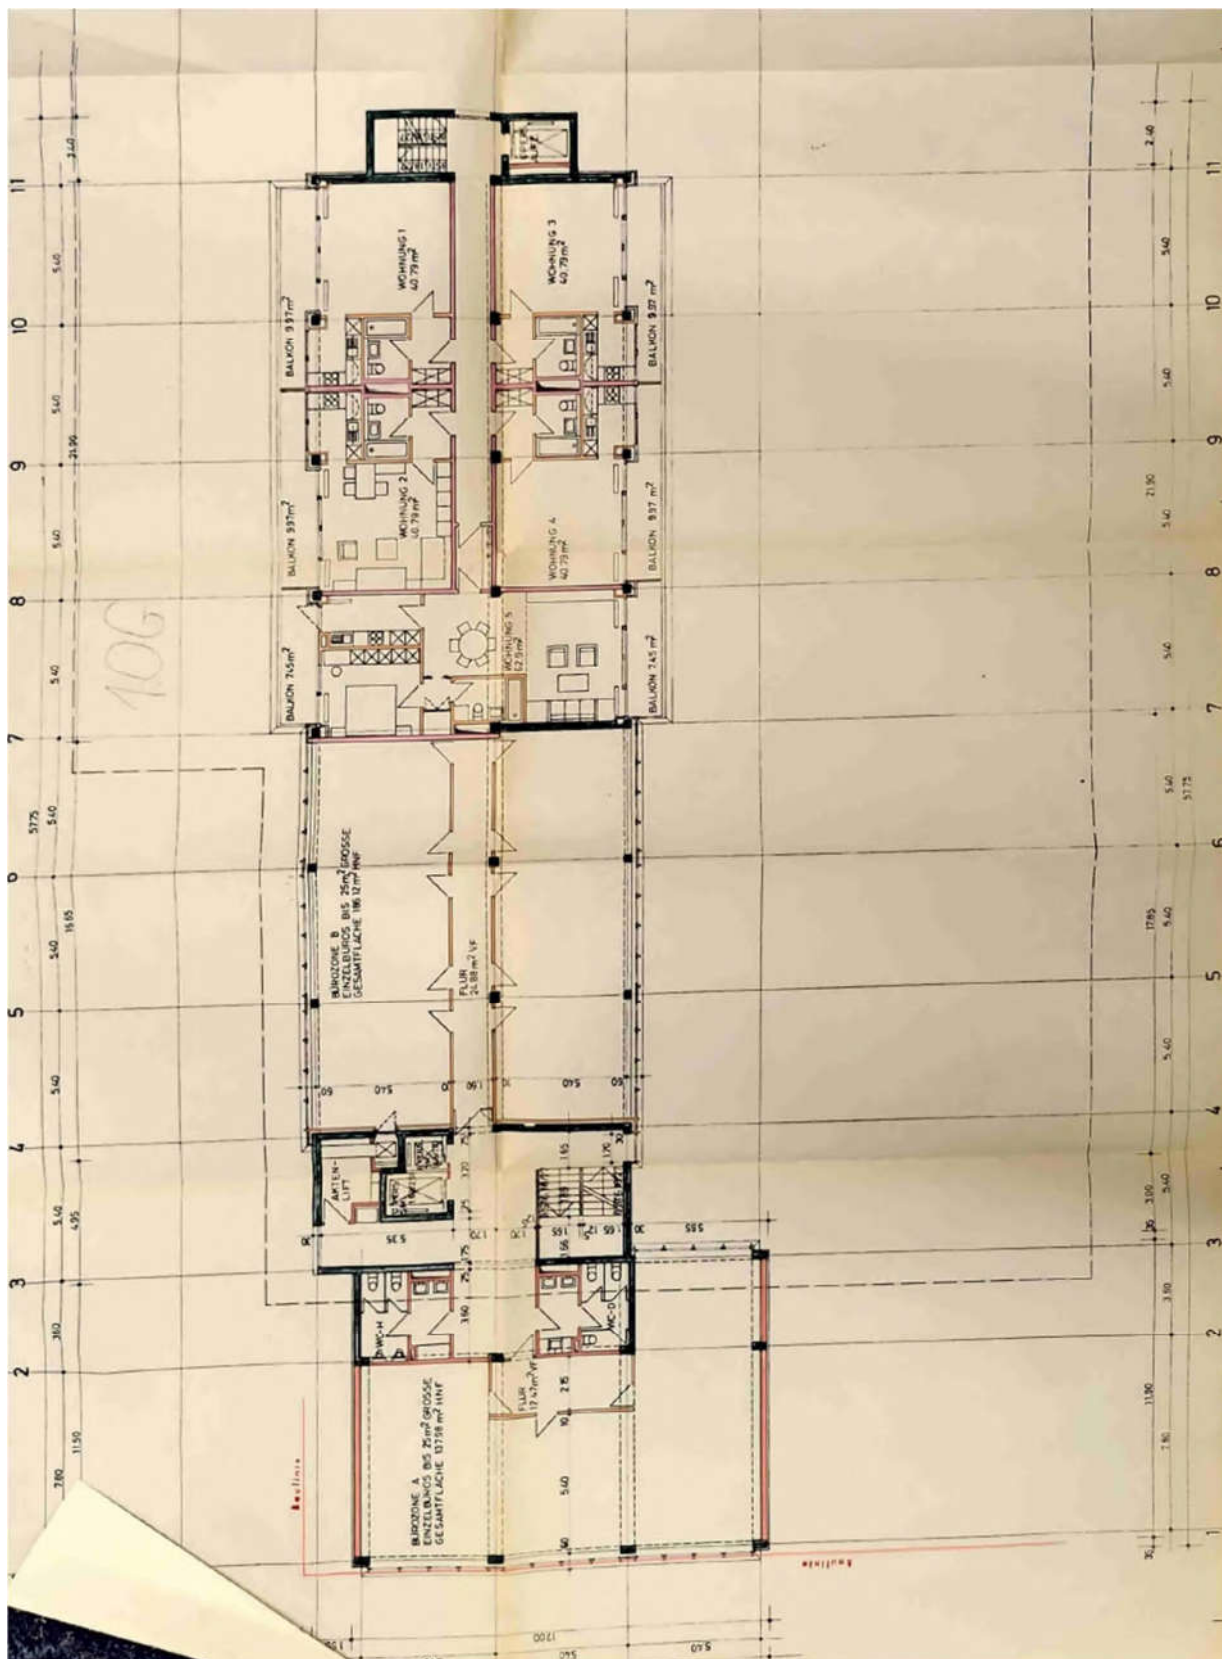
Grundriss 1. Obergeschoss
